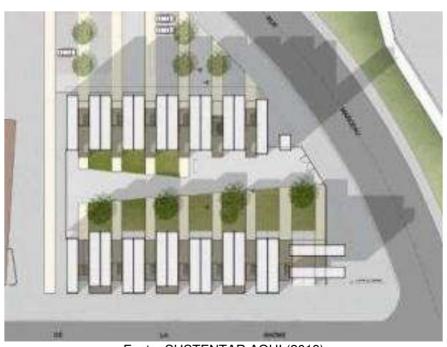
Planta Baixa de Conjunto projetado pelo escritório Cattani Architects
